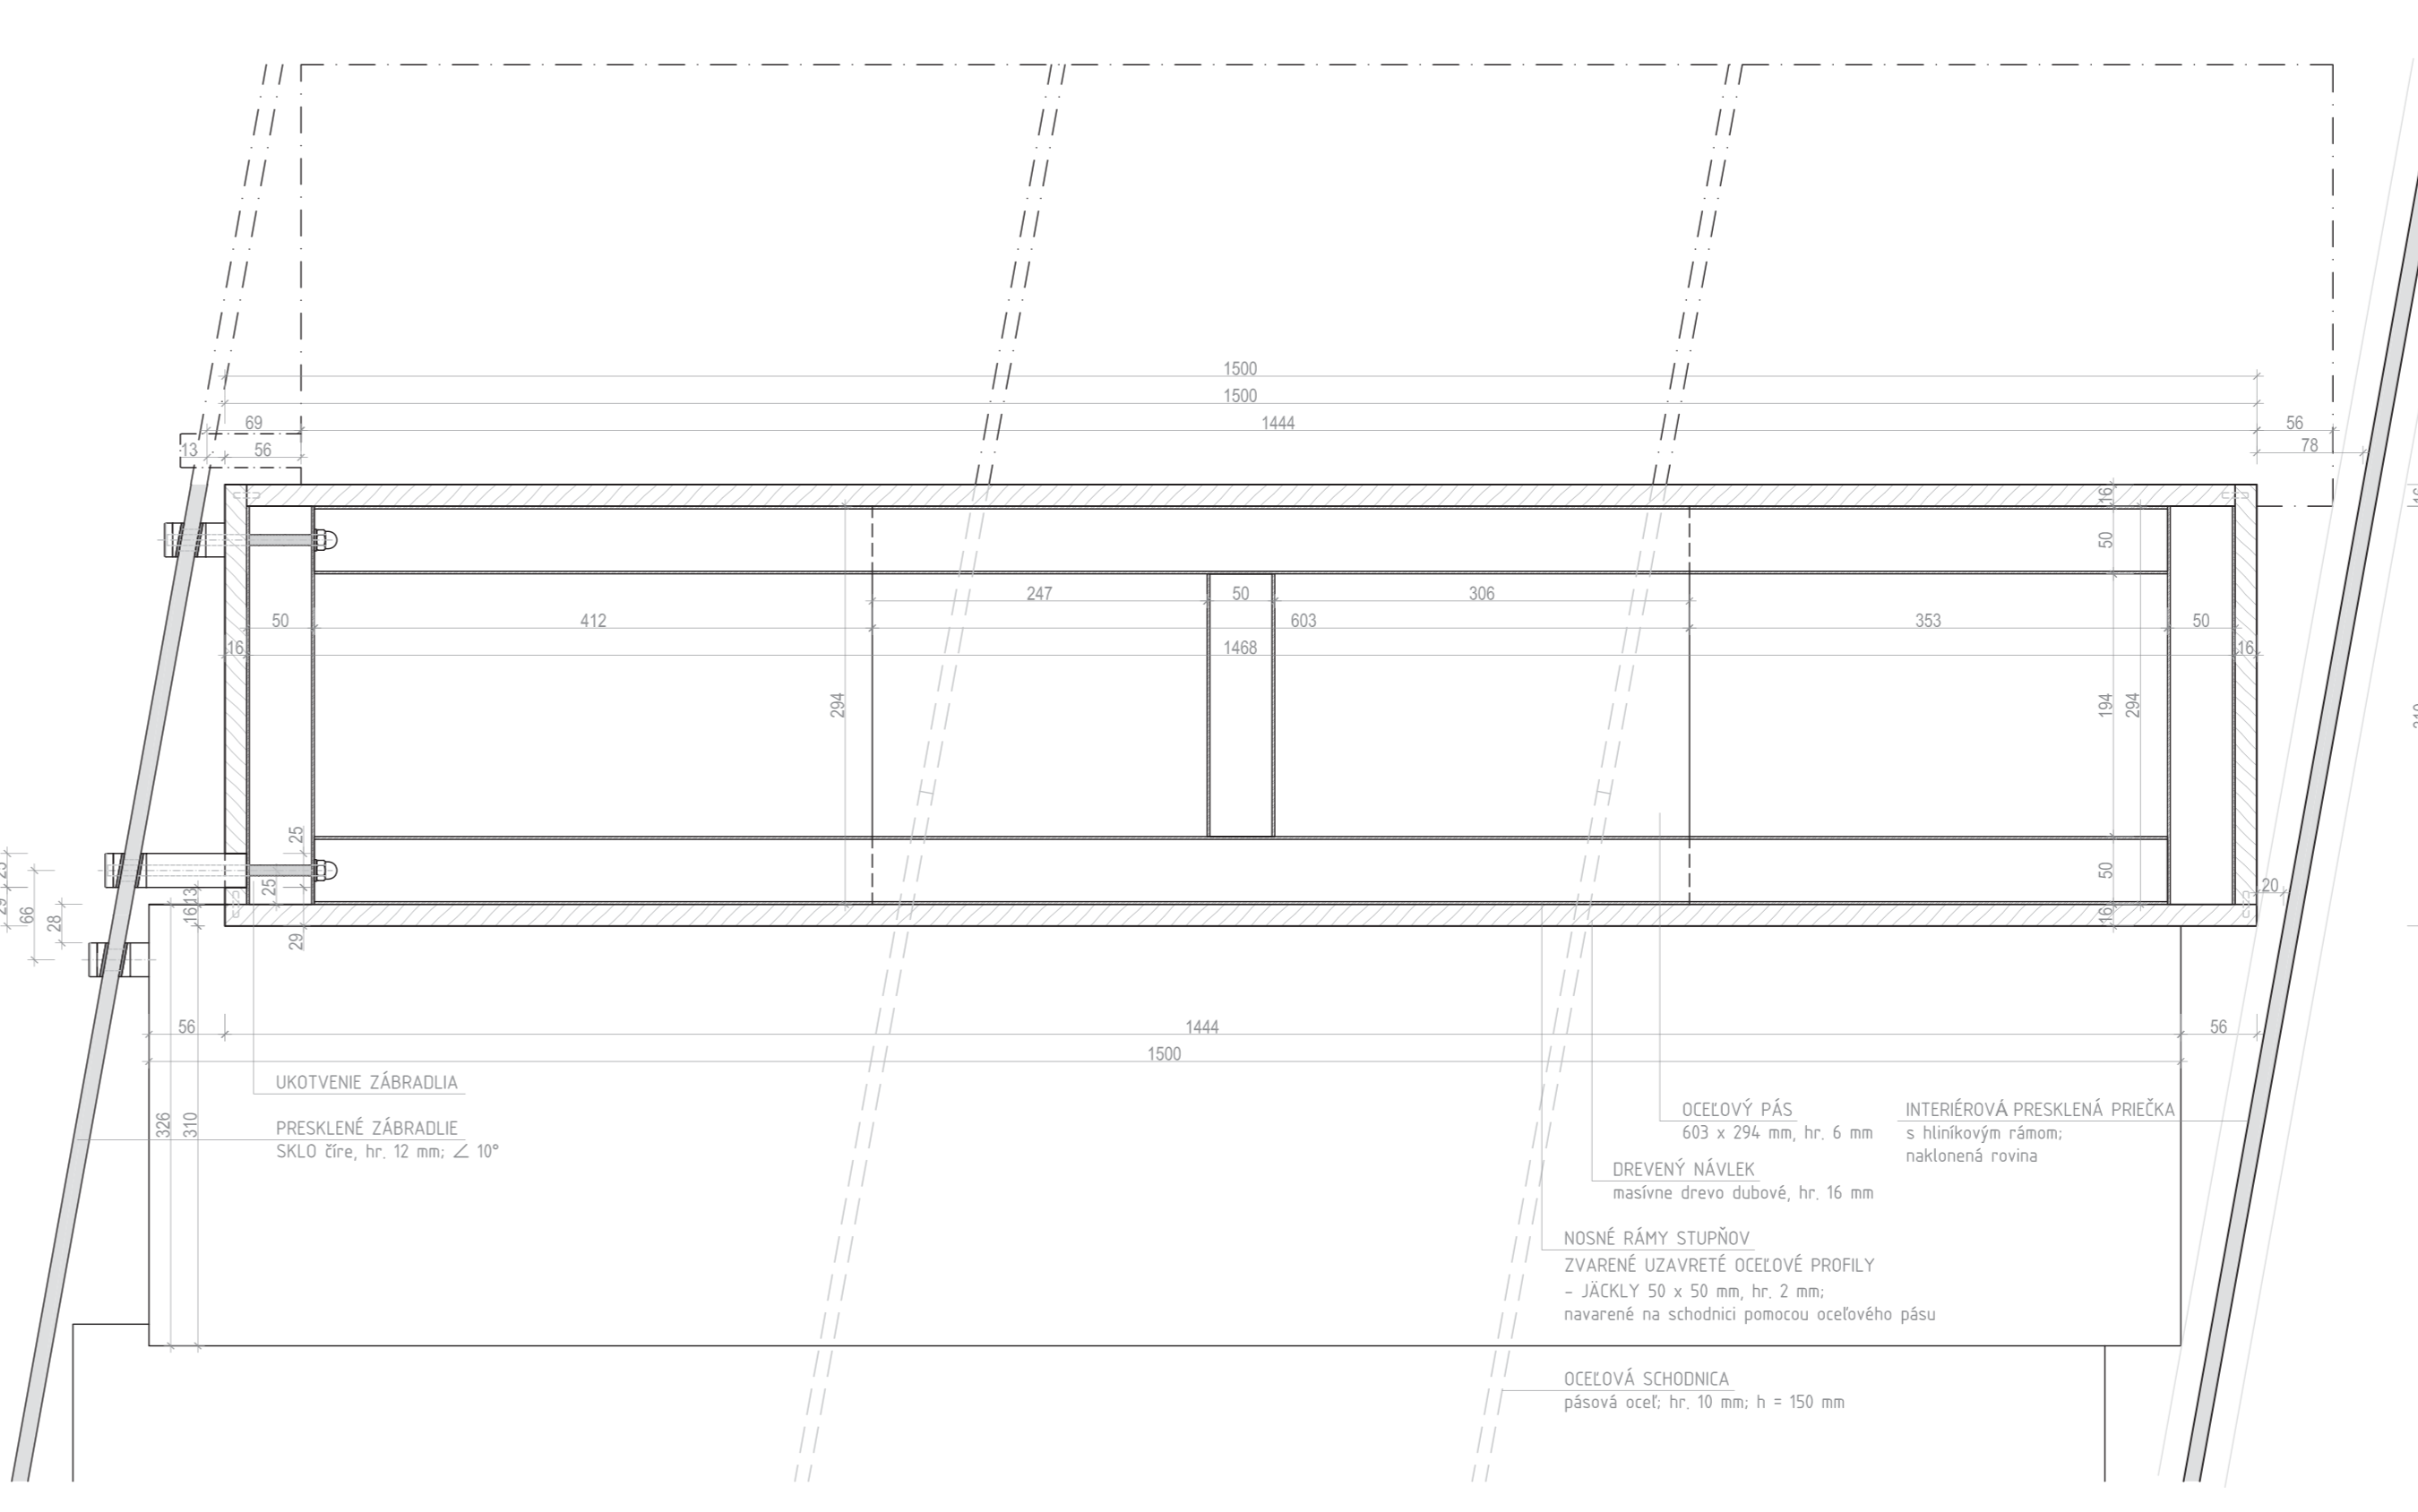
PRIEČNY REZ SCHODISKOVÉHO STUPŇA
